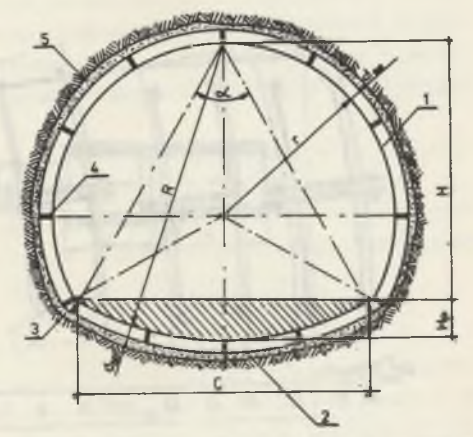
Konstrukcja 5-segmentowej obudowy żelbetowej o kształcie kołowym
